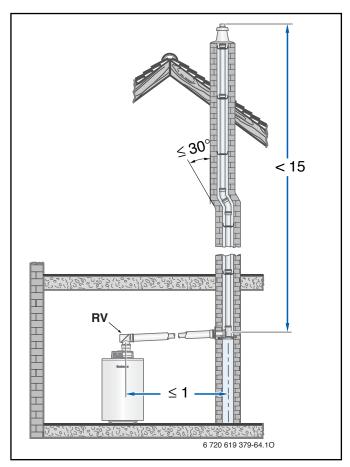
Esempio di disposizione di apertura di ispezione per condotto fumi senza deviazione in locale di posa (quote in m)
